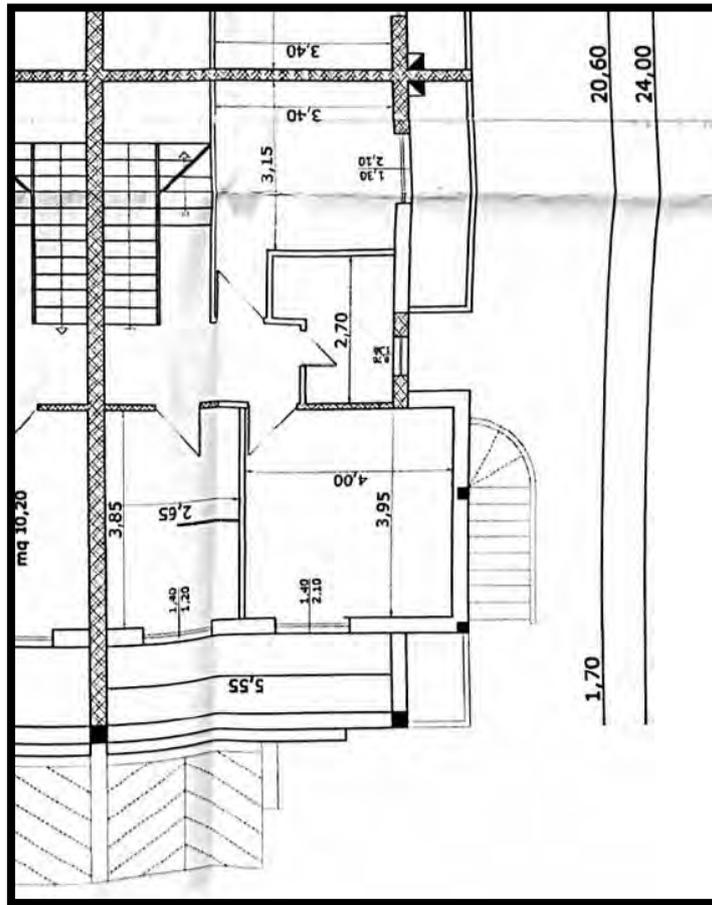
Pianta piano secondo allegata alla CILA prat. n. 294/2011
